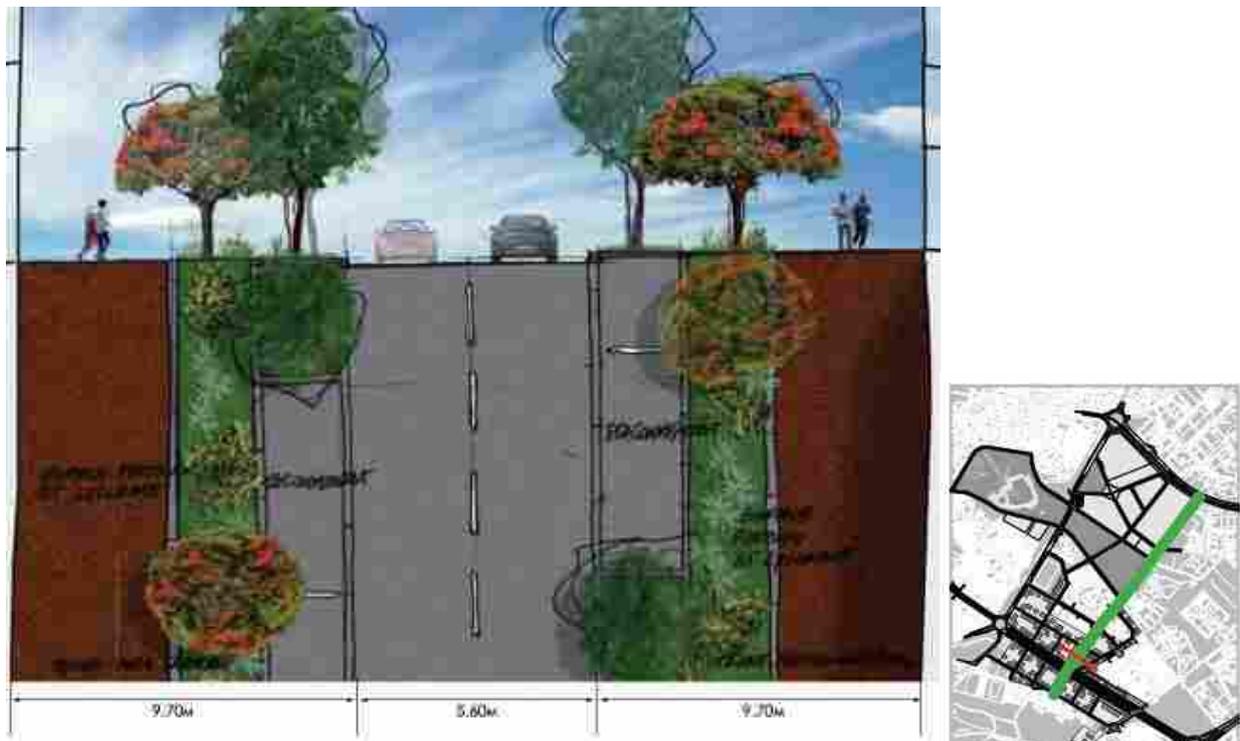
Profil en travers proposé au droit de la future voie structurante
